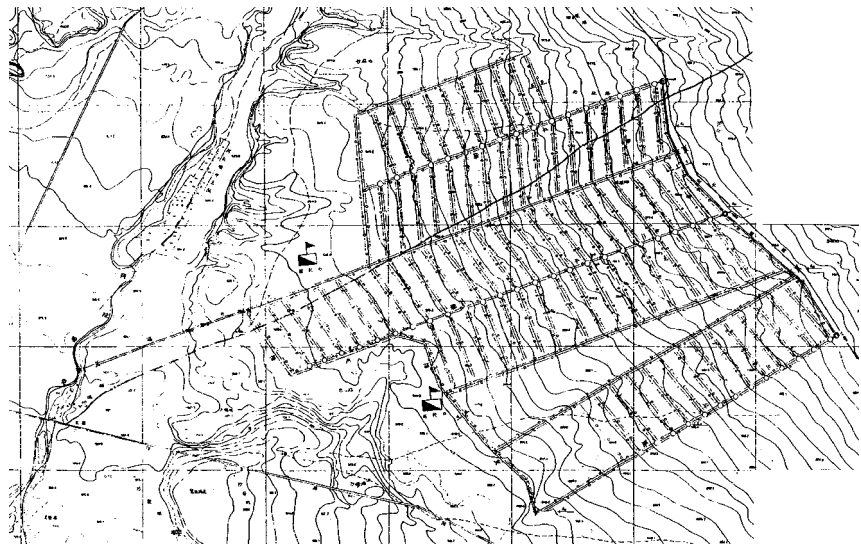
阿勒泰市阿拉哈克开发区平面图
